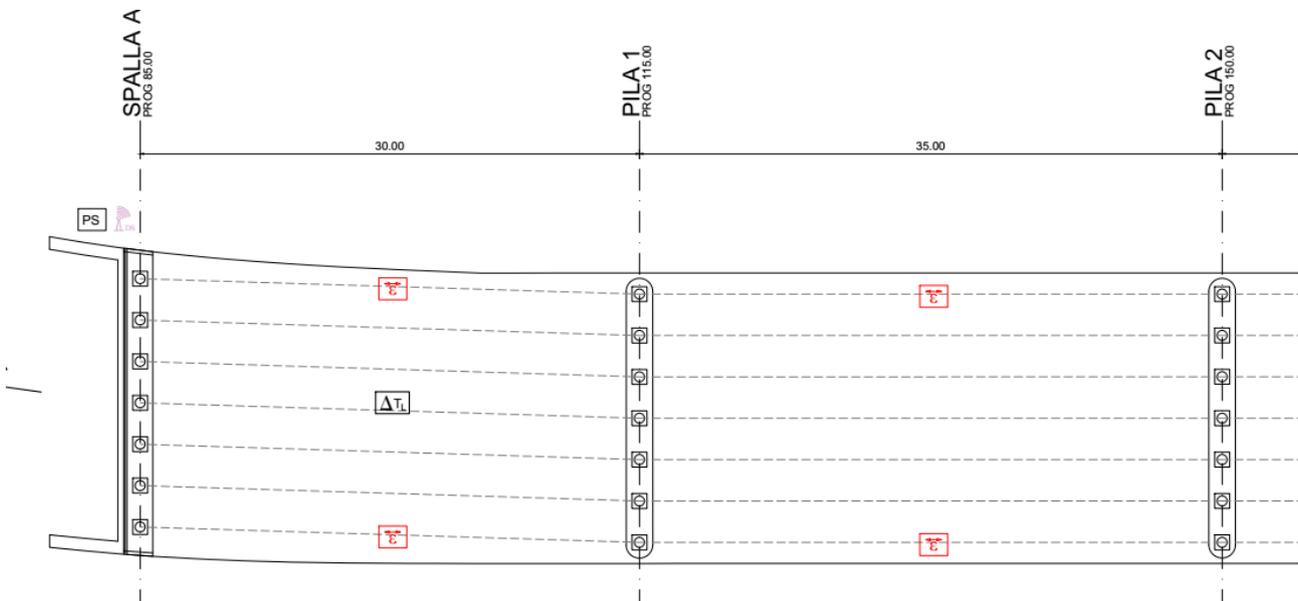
Ubicazione sensori su impalcato sezione a 7 travi (Pianta viadotto Rampa bidirezionale)
